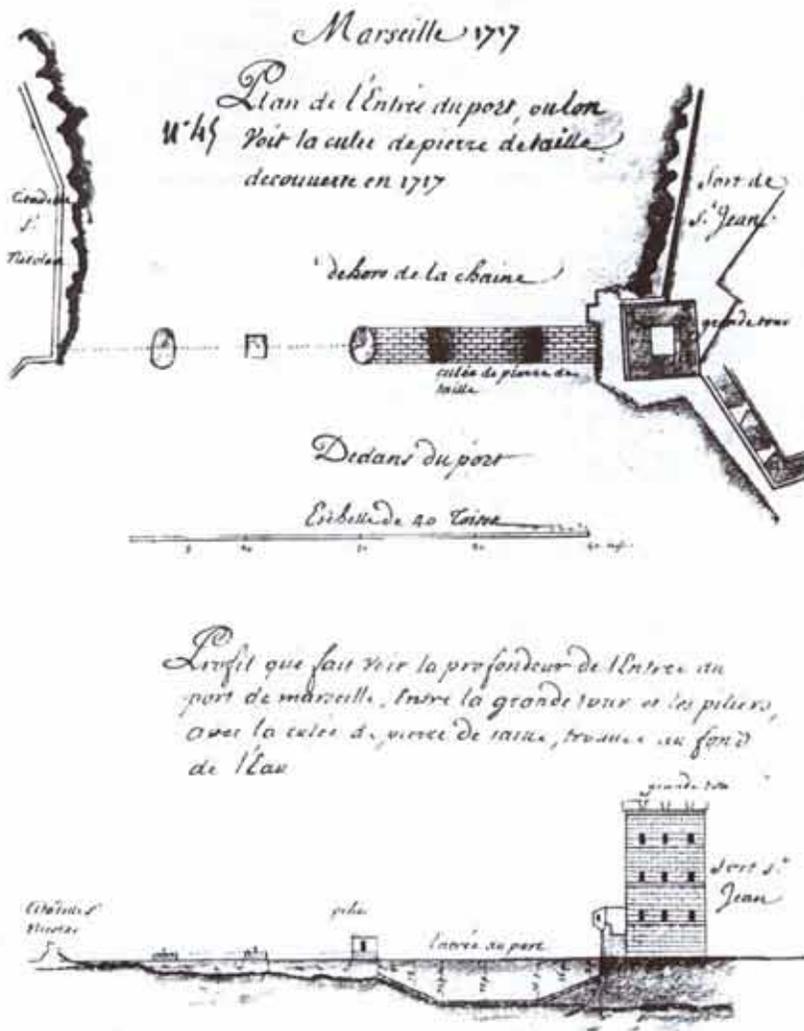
Plan et coupe de la passe du port en 1717 (collection privée ; CRDP, R. Baudraz).
